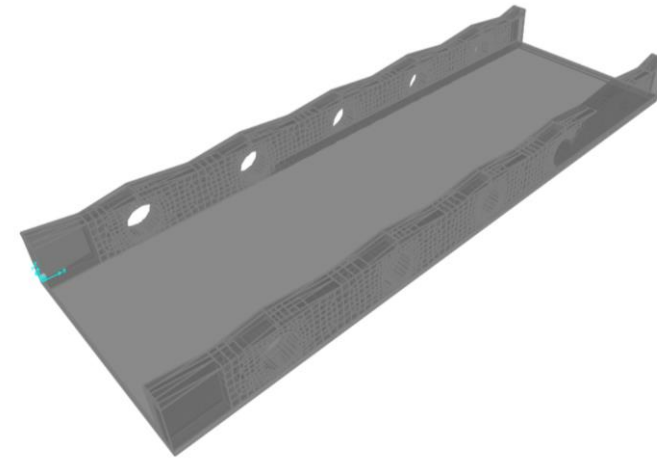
Vista general alternativa 3. (Fuente: elaboración propia en SAP2000).
